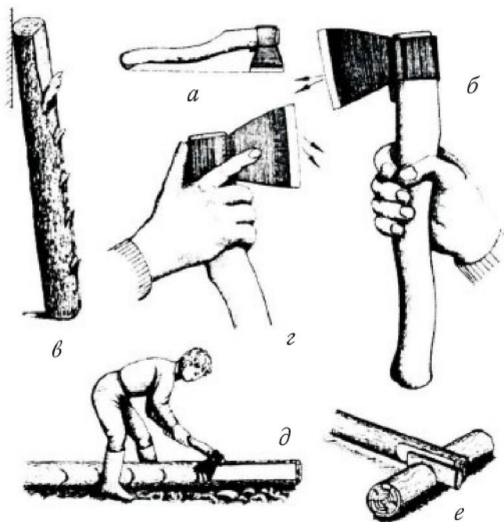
Работа топором: а) насадка топора на топорнице; б) захват одной рукой при маховых ударах и снятии большой массы древесины; в) предварительные зарубки при тесании плоской поверхности; г) положение правой руки при чистовой обработке древесины; д) и е) тесание бревна с зажимом его конца клином
